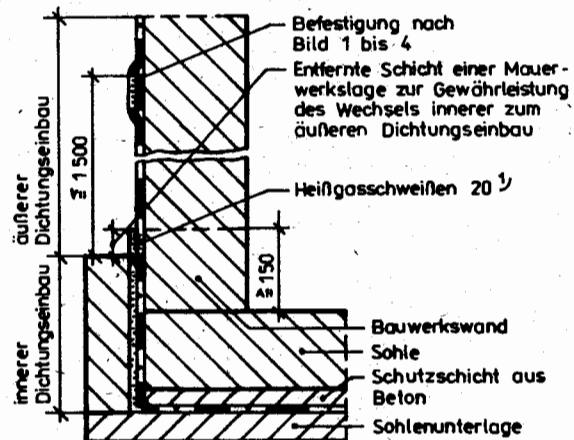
Wechsel innerer zum äußeren Dichtungseinbau, z. B. Anschluß nach Abstemmen mindestens einer Mauerwerkslage
